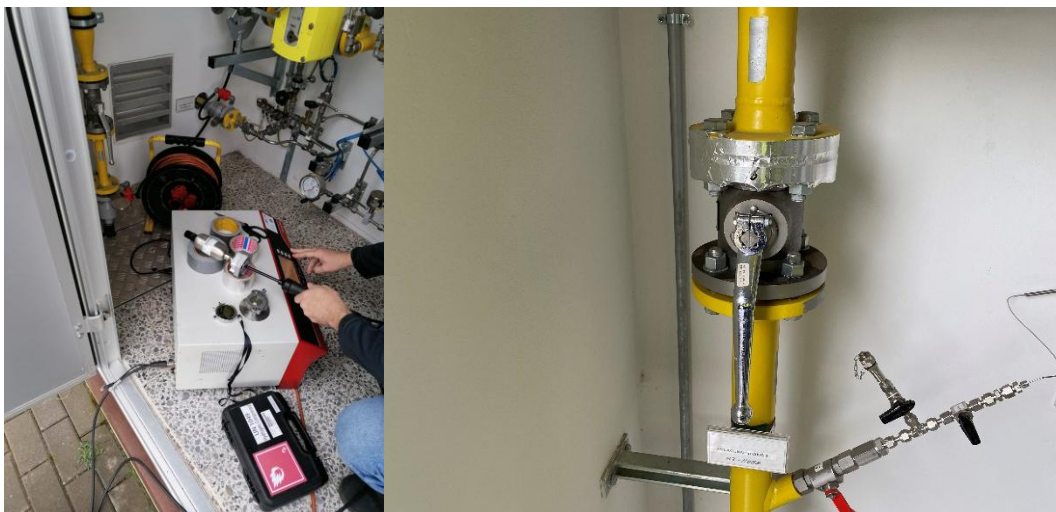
Messgerät für die Leckagemessung und abgeklebte Flanschverbindung
